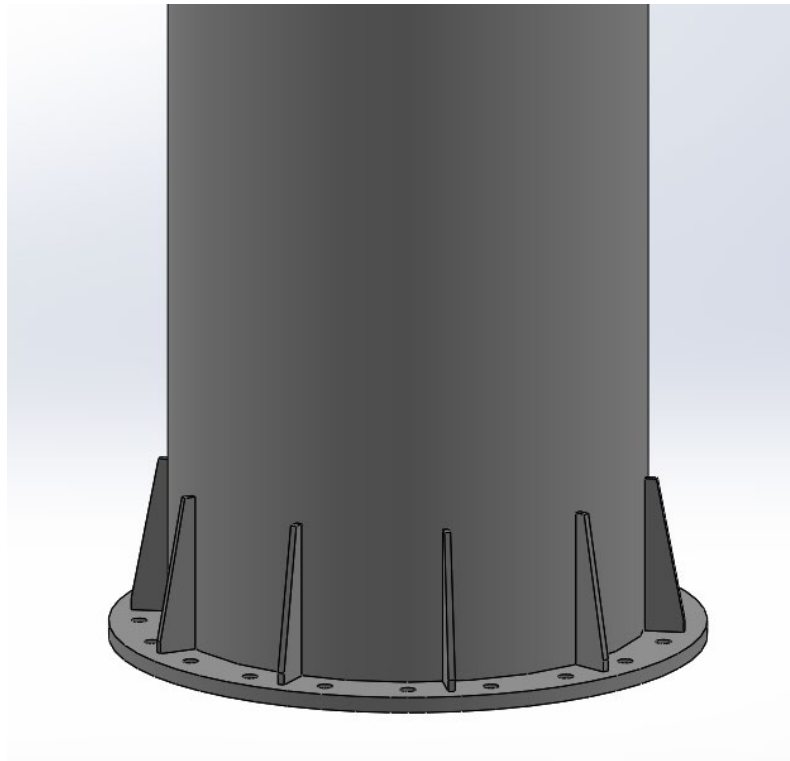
Detalle de placa de anclaje y cartelas de refuerzo inferior de la columna.
